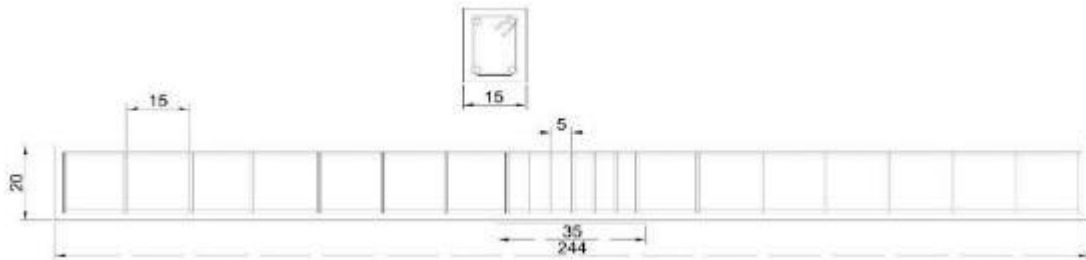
Armado de la viga con traslape en el acero longitudinal a tensión.
